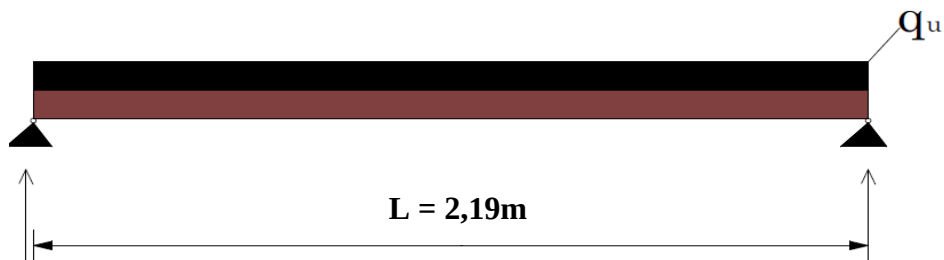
Schéma statique d'un plancher collaborant sur deux appuis
